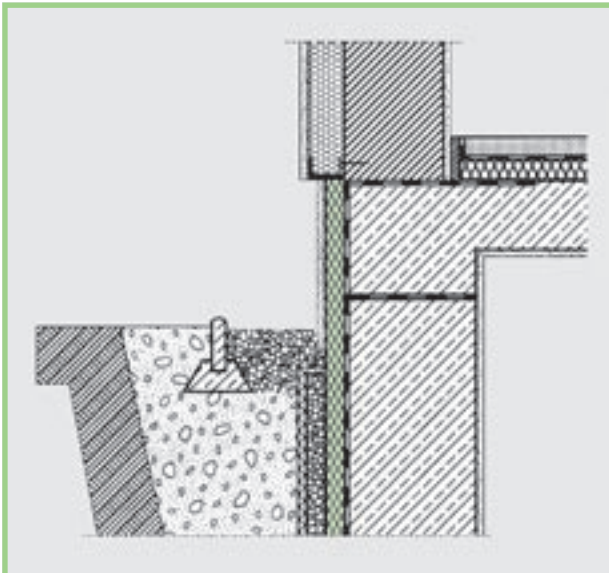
Sockelbereich, Perimeterdämmung mit außen liegendem Wärmedämmverbundsystem.
